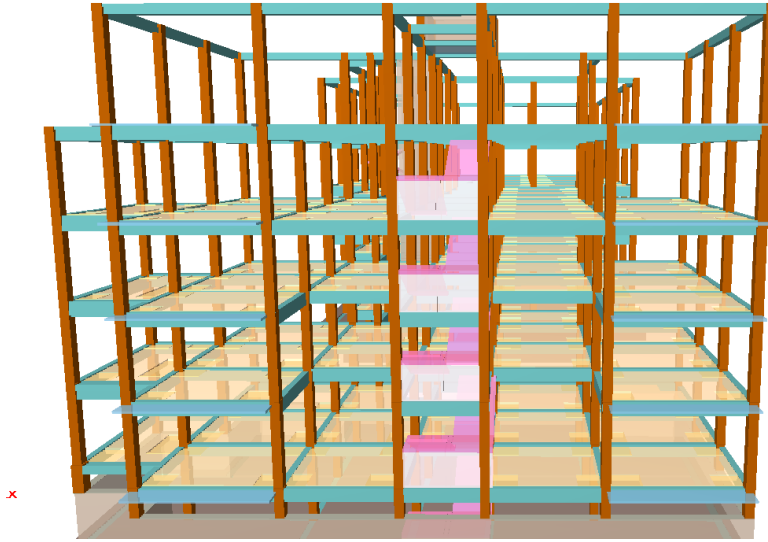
Vista de los entresijos de losa en dos direcciones de la estructura.
